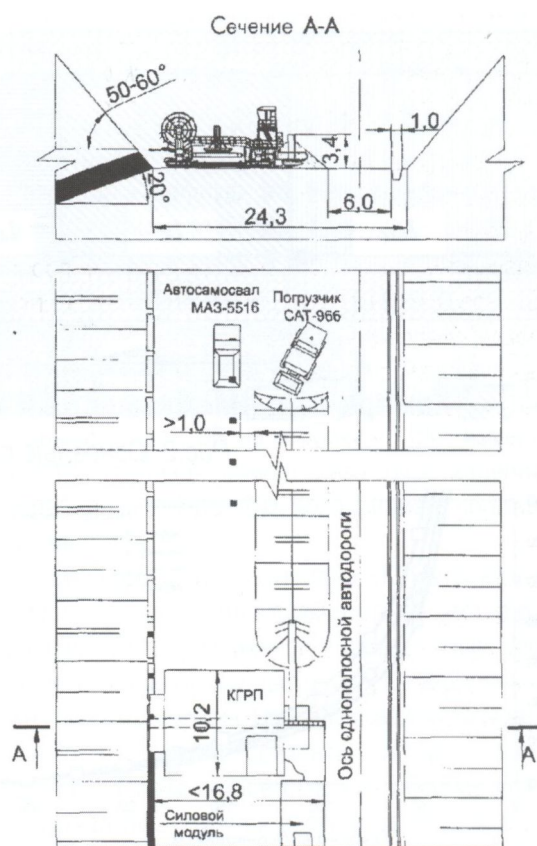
Схема отработки пласта с применением «Superior Highwall Mining»
